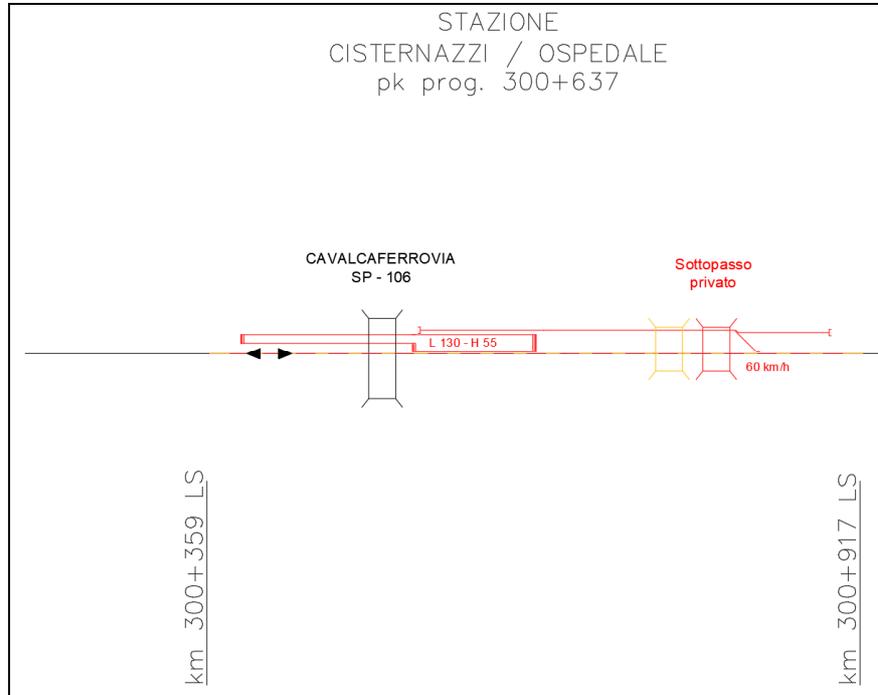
Layout funzionale stazione Cisternazzi/Ospedale
